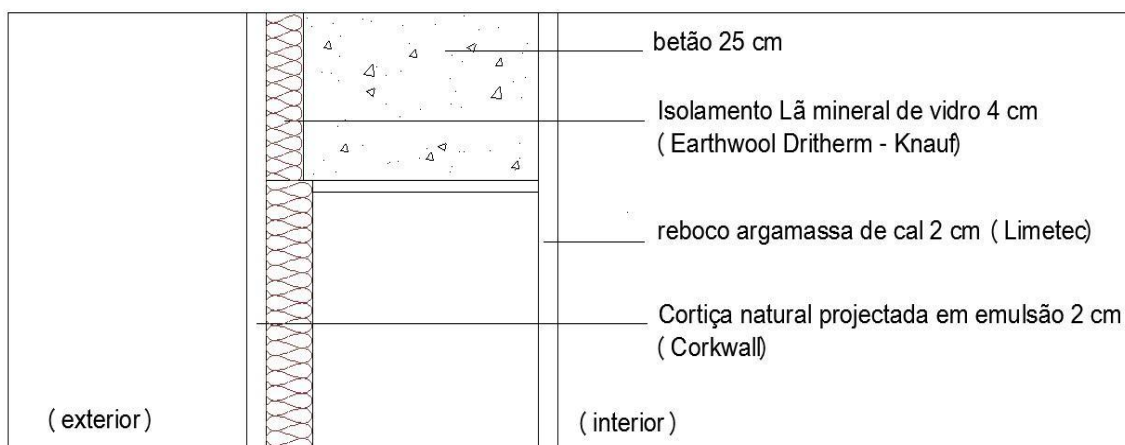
Pormenor construtivo de zona de ponte térmica plana (pilar ou talão de viga) proposta na solução 3
